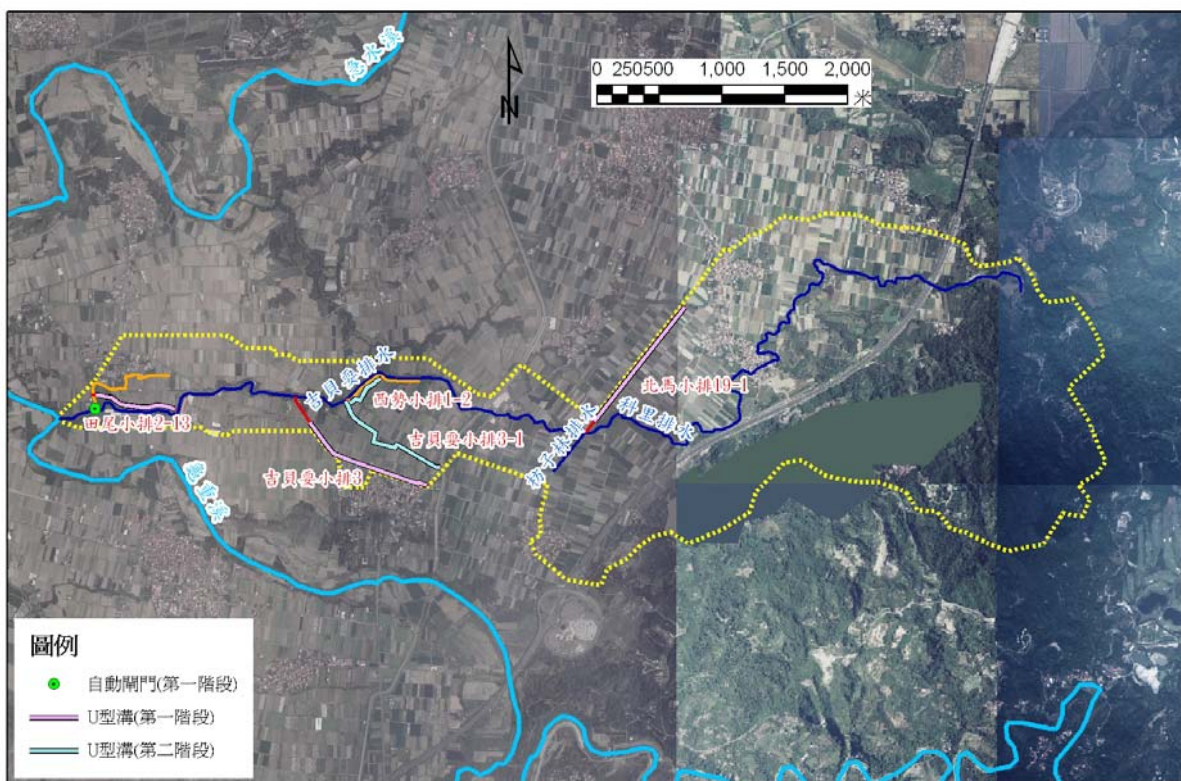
吉貝要排水系統農田排水路工程平面布置圖
